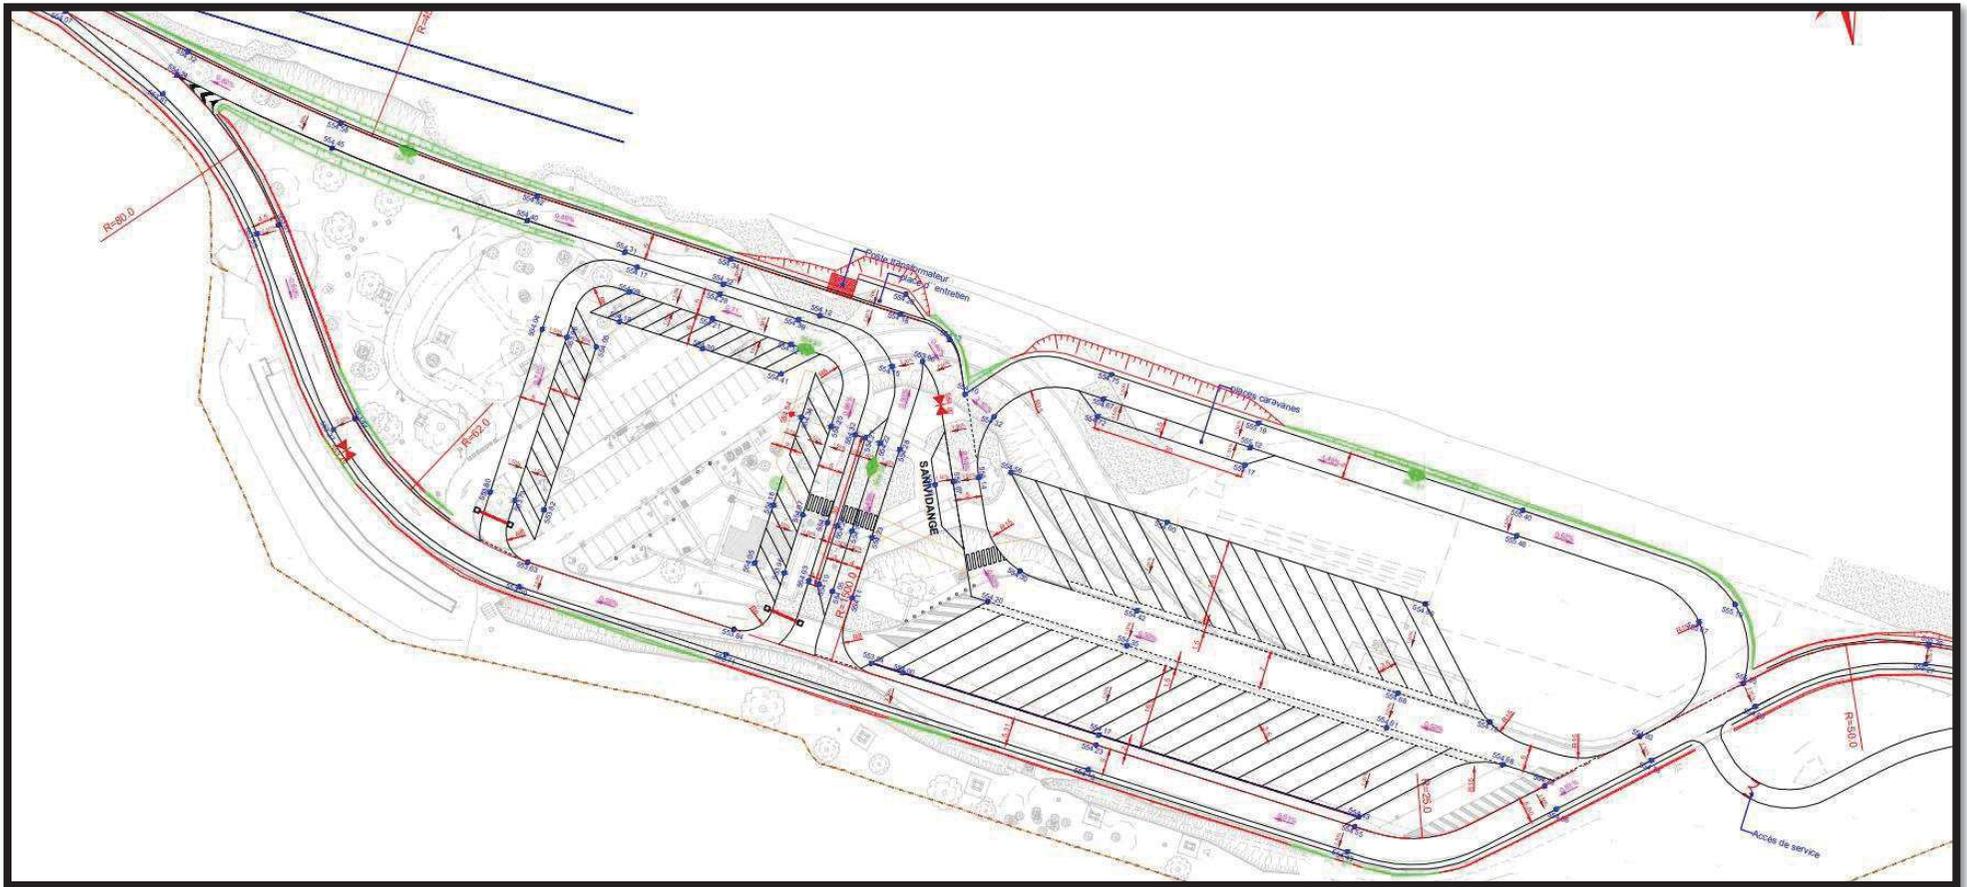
Plan de nivellement du projet (Source : TTK, Rapport Projet, Août 2022).
